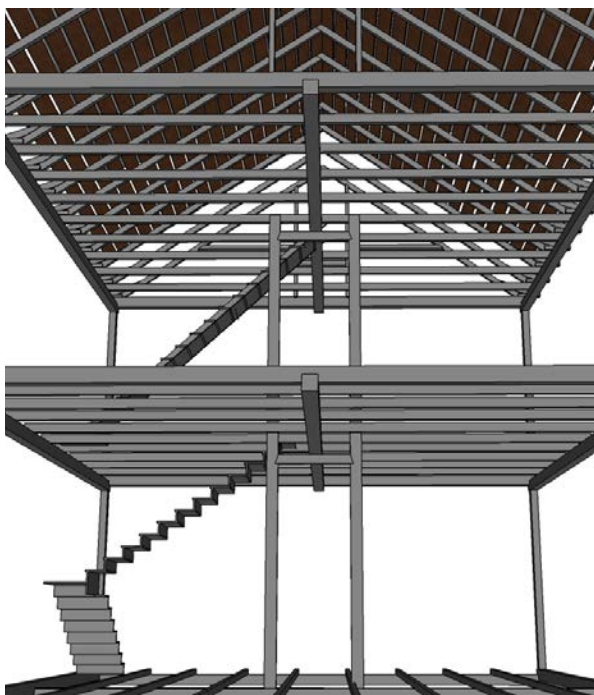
Simulación 3D de la estructura en pórtico en el centro de la vivienda. Posible observar en detalle los encajes entre las piezas de madera que soportan la viga central que atraviesa la casa. Dibujo de la autora.
